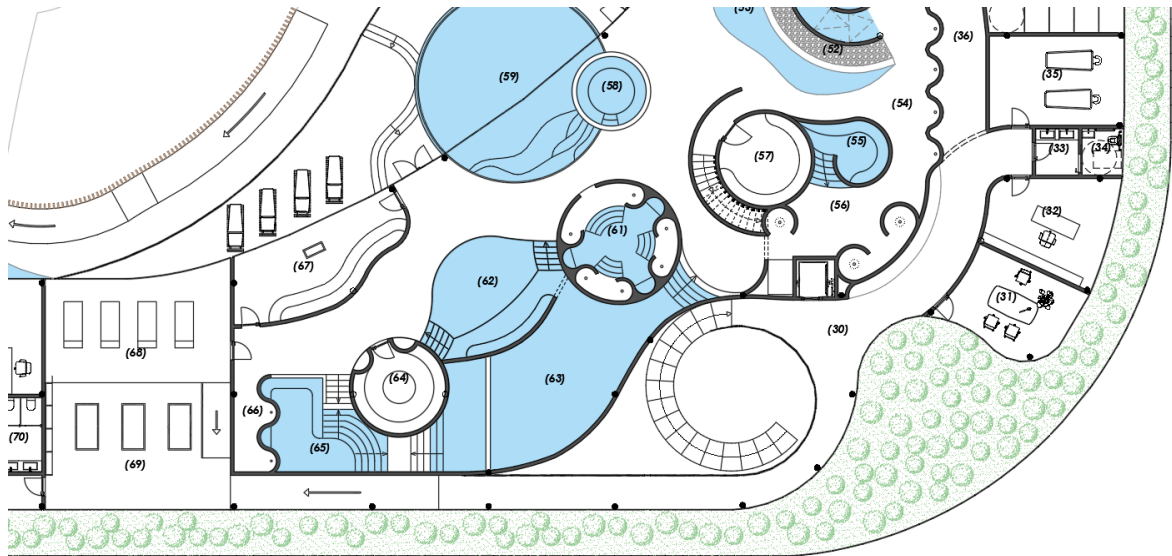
PLANTA DA ZONA SECA DO PISO 1
